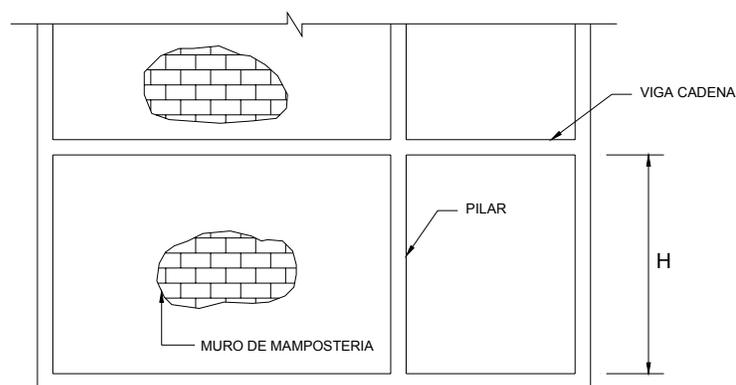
PILARES Y VIGAS CONFINANTES
